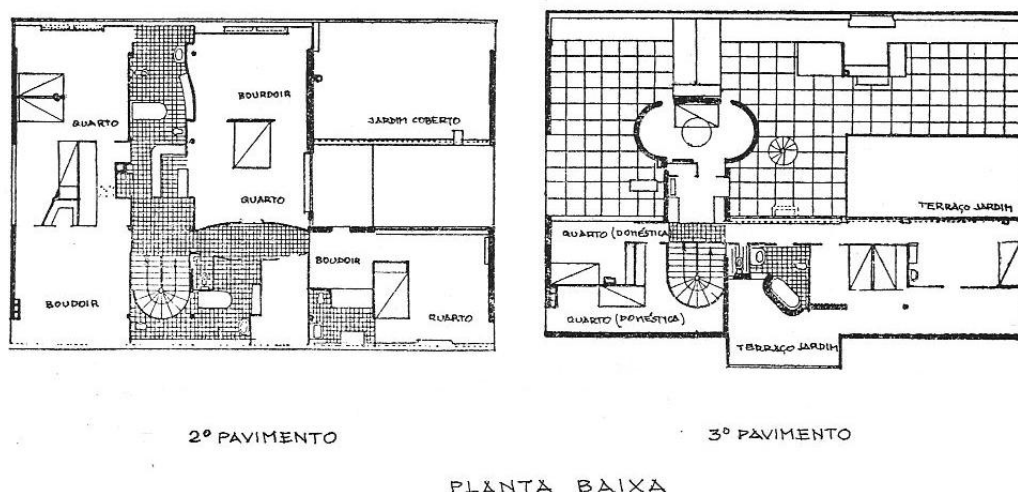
Plantas da Villa Stein - de Monzie, em Garches: segundo e terceiro pavimentos.
